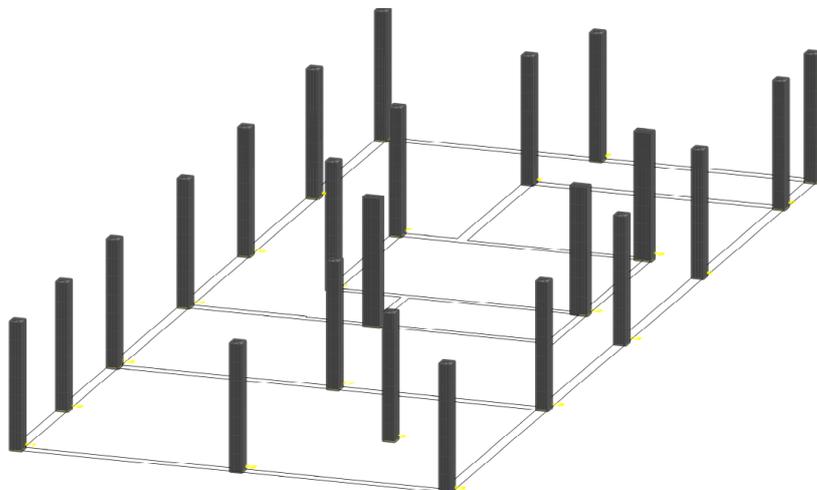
Planta 3D da proposta para fundação em concreto armado
